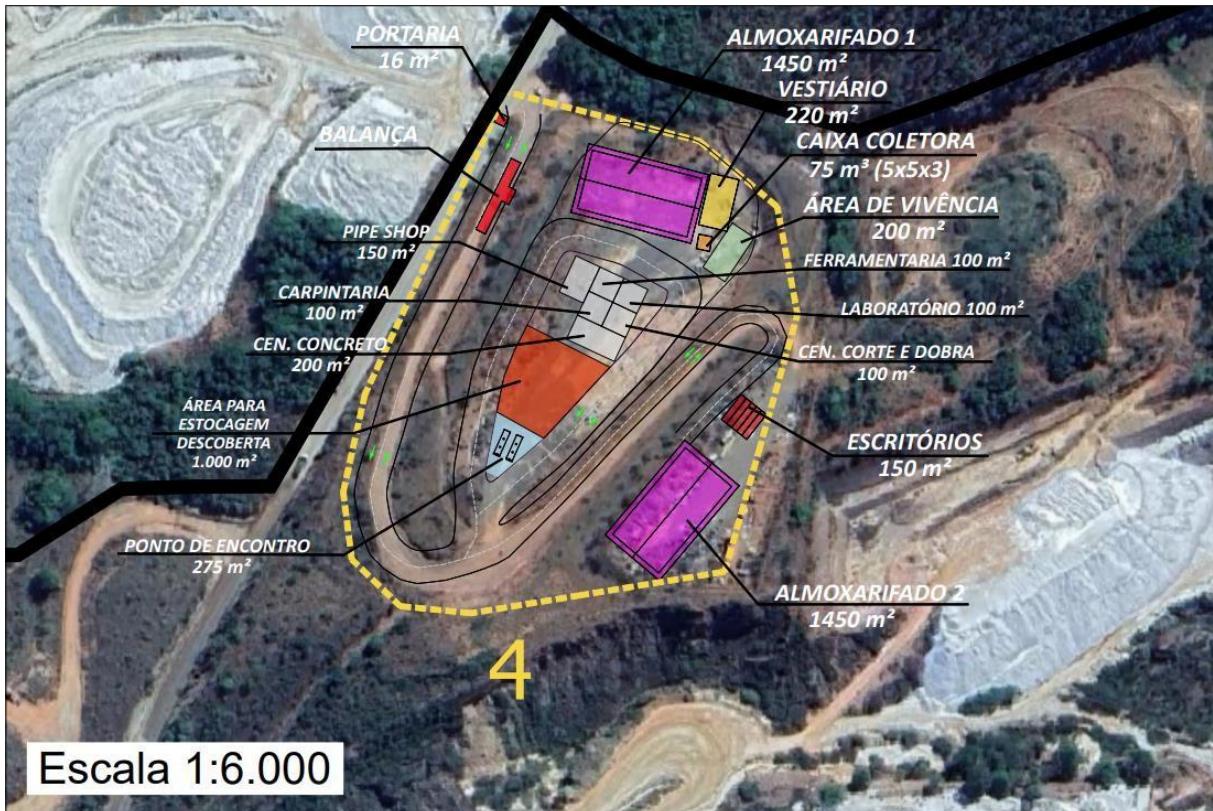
Canteiro de obra a ser implantado. Fonte RCA.
